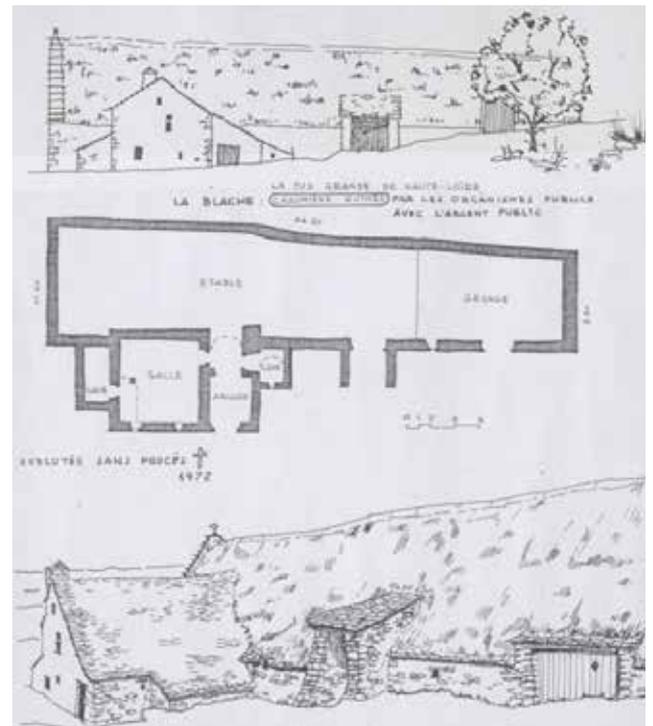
Plan d'une ferme du Mézenc - Jean Pestre
